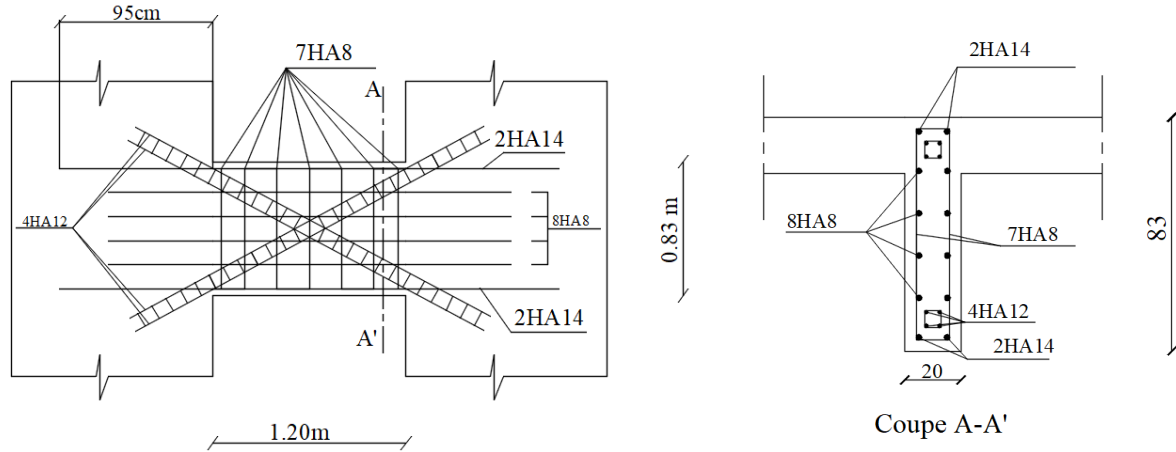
Schéma de ferrailage du linteau VL1 (Zone I).
